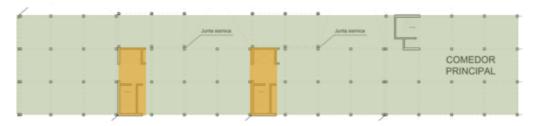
Placas estructurales del proyecto Fuente: Elaboración propia
